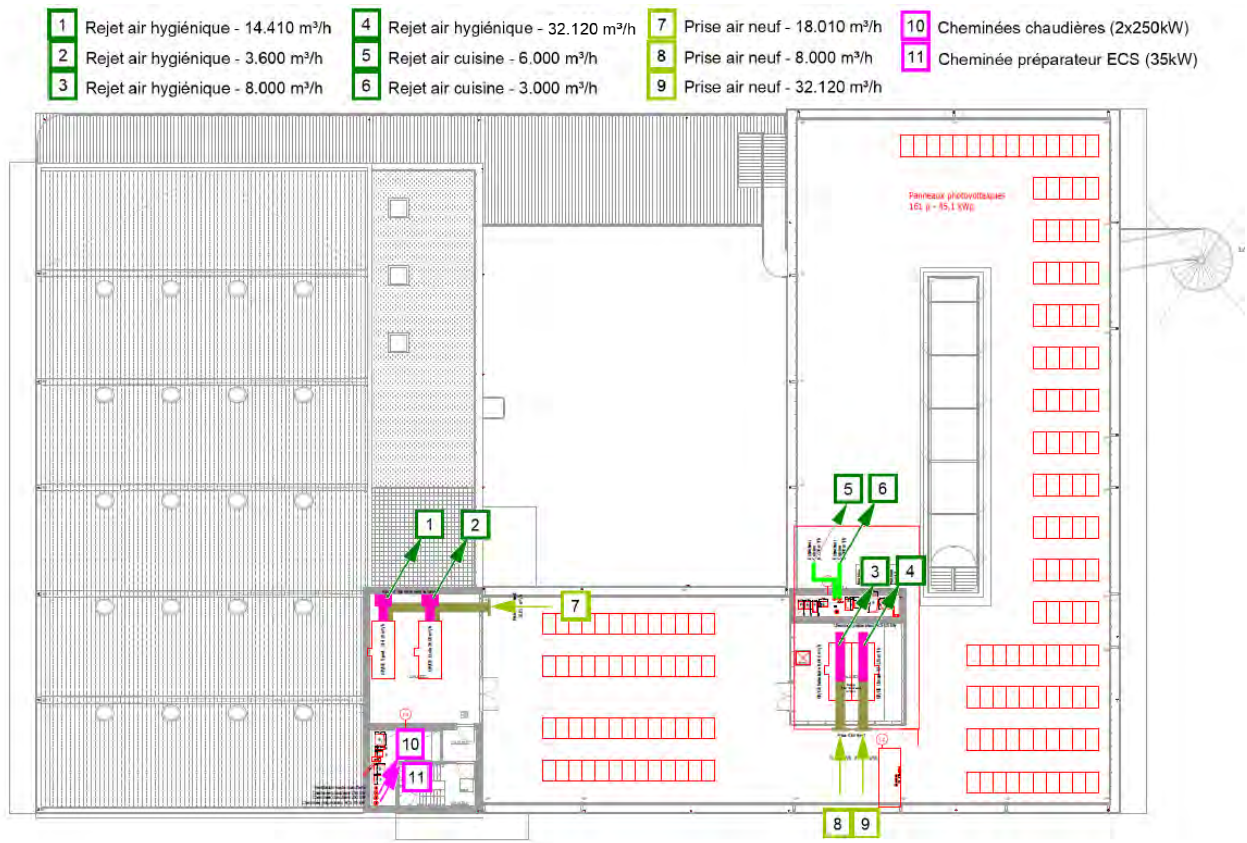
Localisation des prises d'air neuf au niveau de la façade et des rejets d'air au niveau de la toiture du bâtiment DOA (MK Engineering, 2018)
